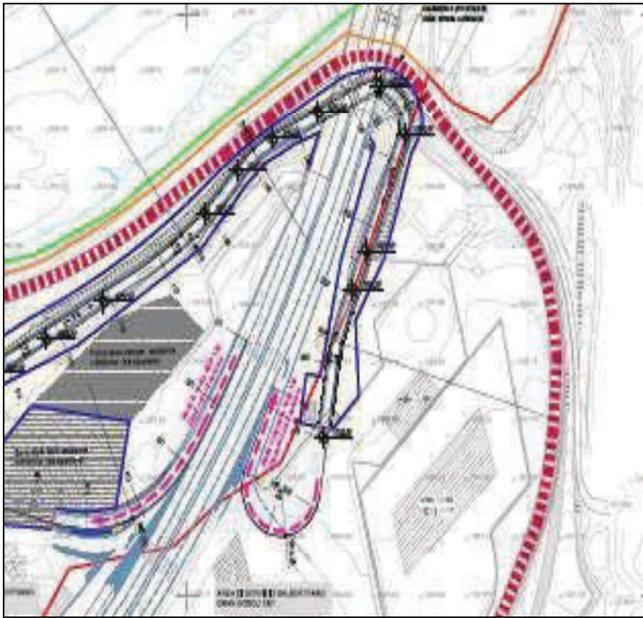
Viabilità di entrata in A32 dal Cantiere secondo il PRV
